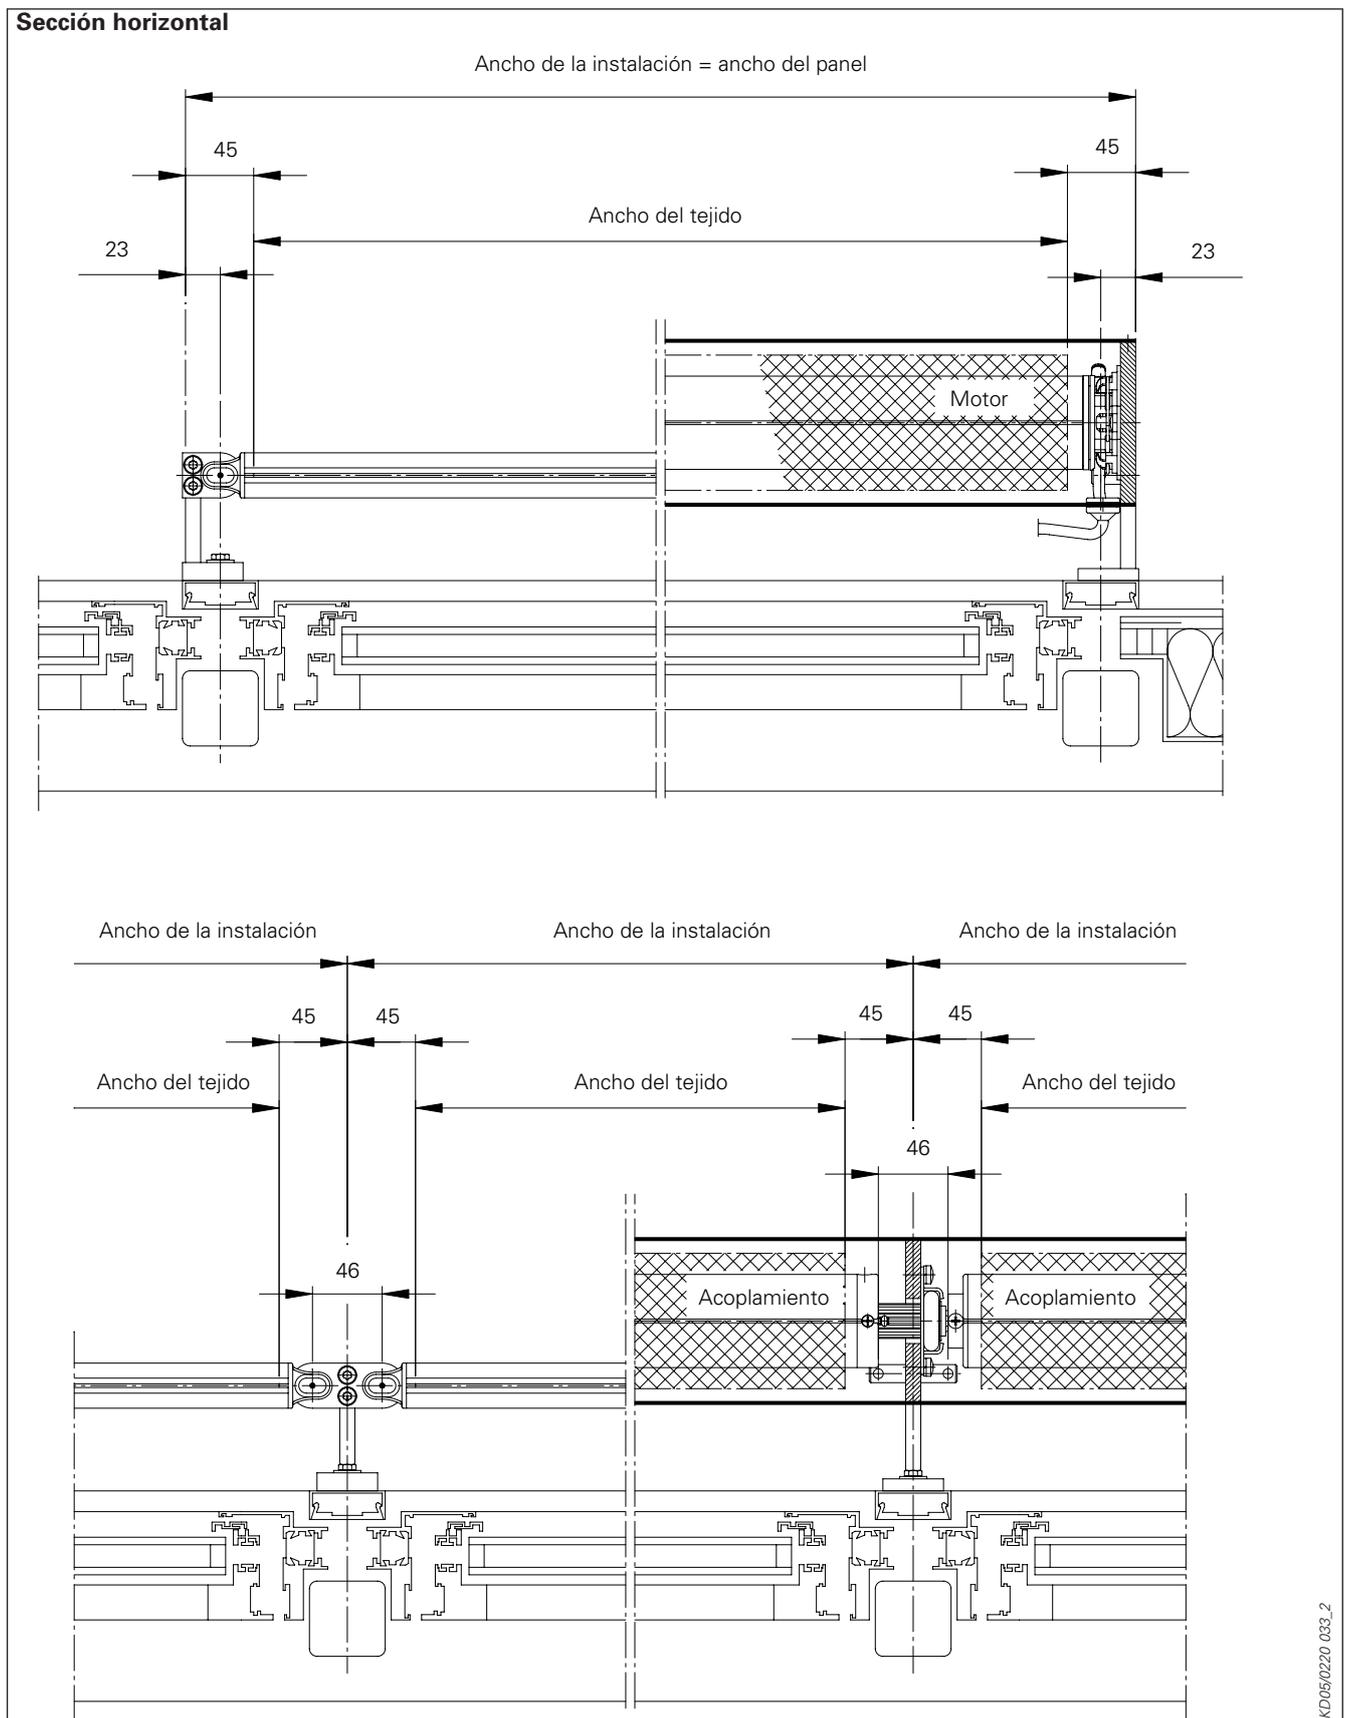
Sección horizontal toldo para fachadas modelo 209 E con protector redondo modelo 23.3 y cable de guía Ø3,3 mm
